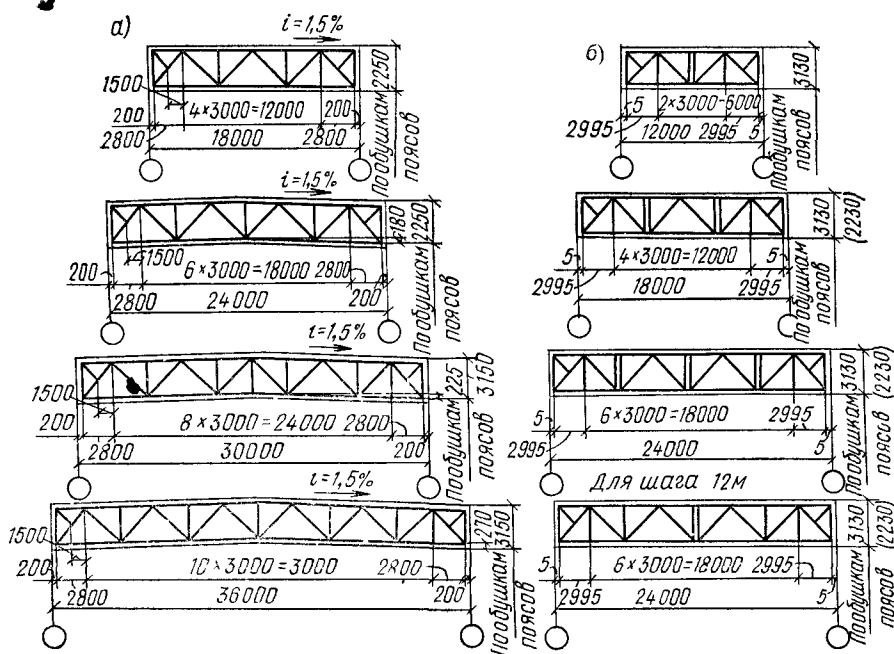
Схемы типовых ферм для покрытий с уклоном кровли 1,5 % (сечения элементов из уголков и тавров)
